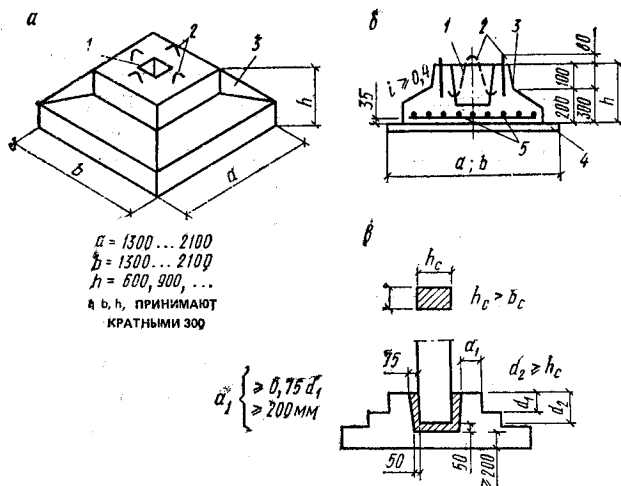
Сборные целые железобетонные фундаменты колонн
